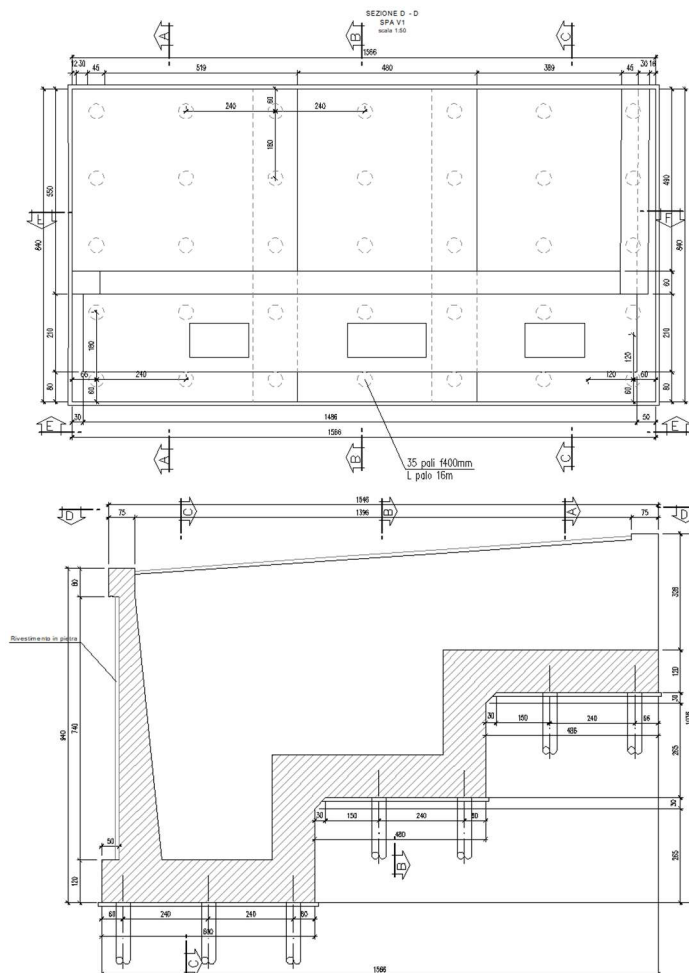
Spalla B: sezione longitudinale e pianta
